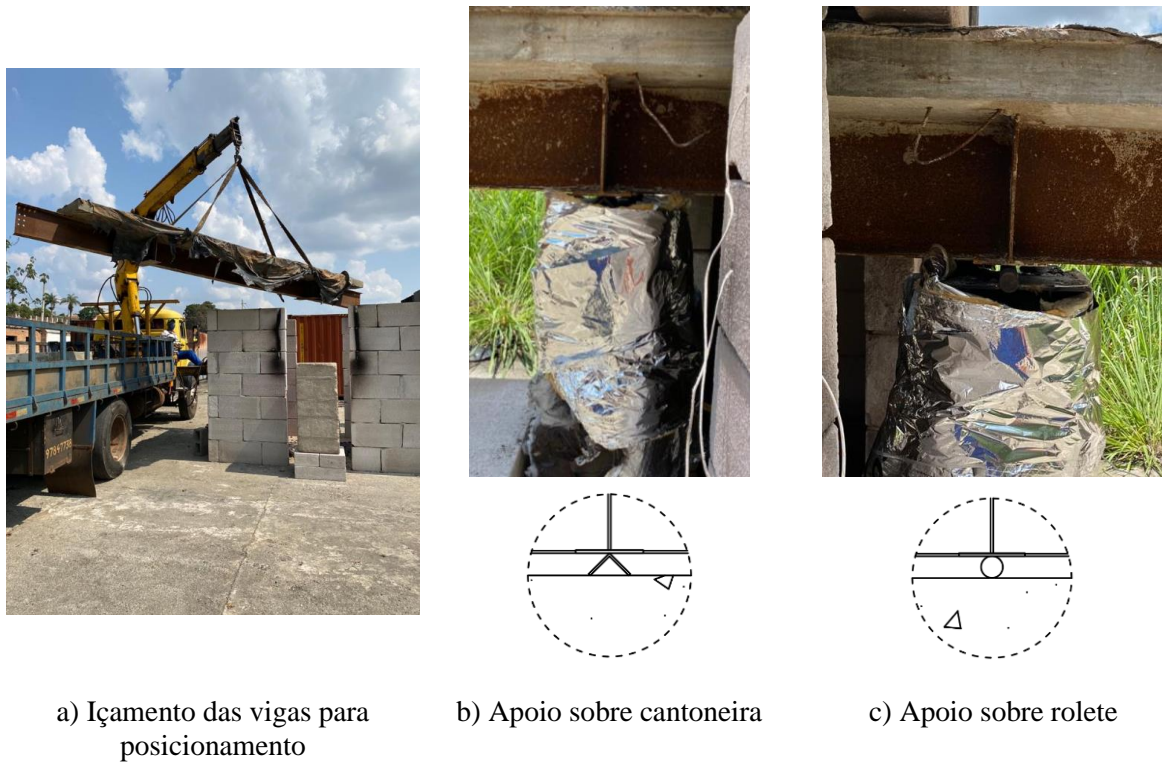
Posicionamento da viga para ensaio e apoios.
